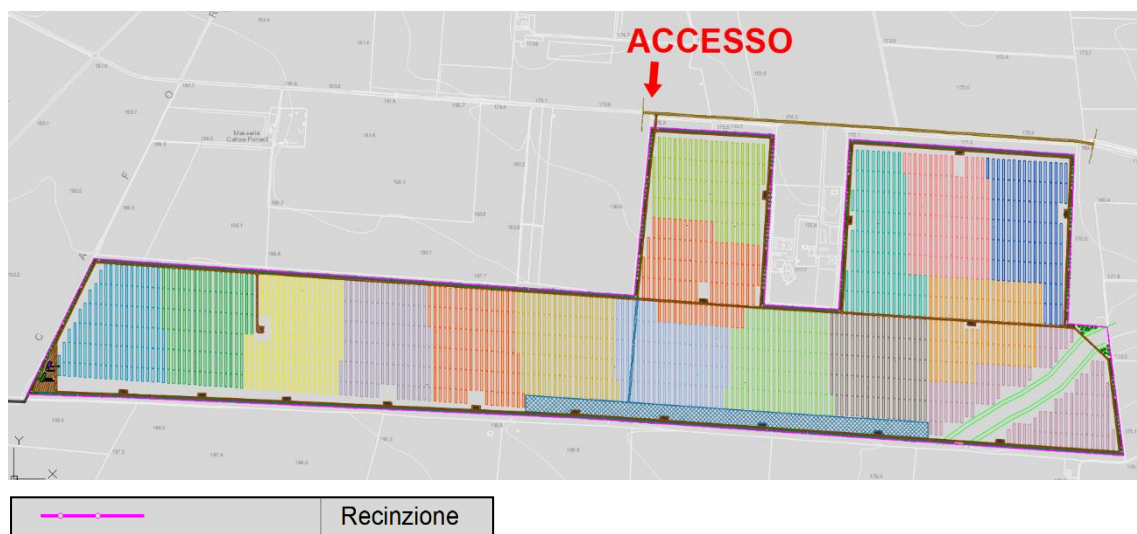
Individuazione dell'area di impianto con indicazione dell'ubicazione del nuovo ingresso all'impianto
